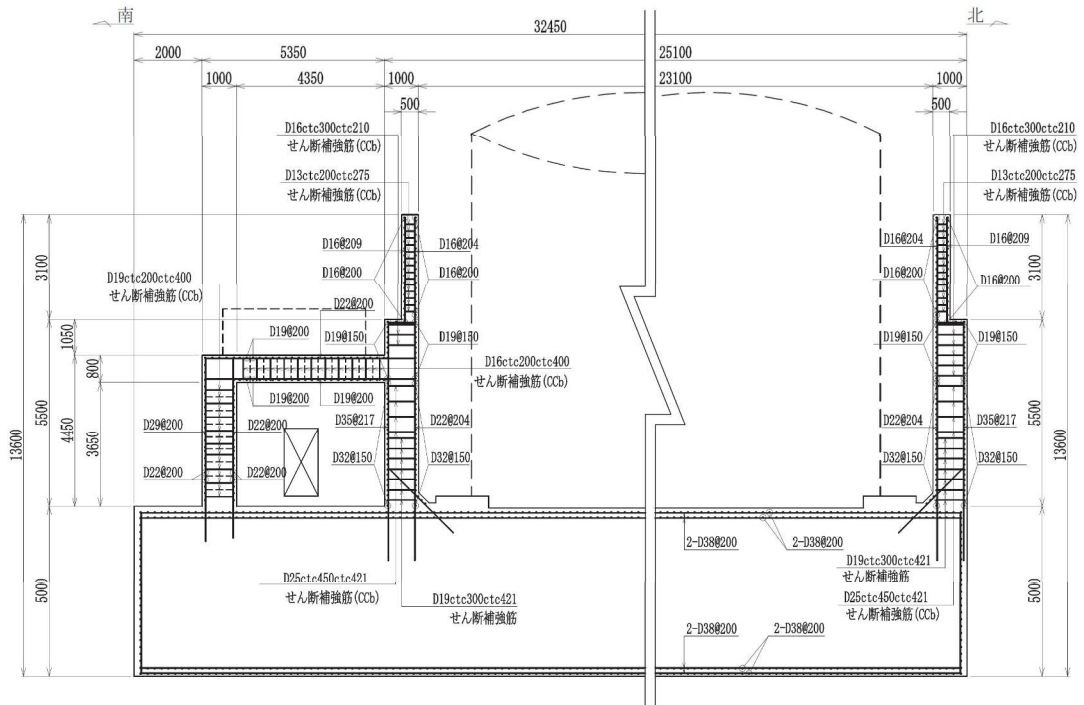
復水貯蔵タンク基礎 概略配筋図 (1-1 断面)
